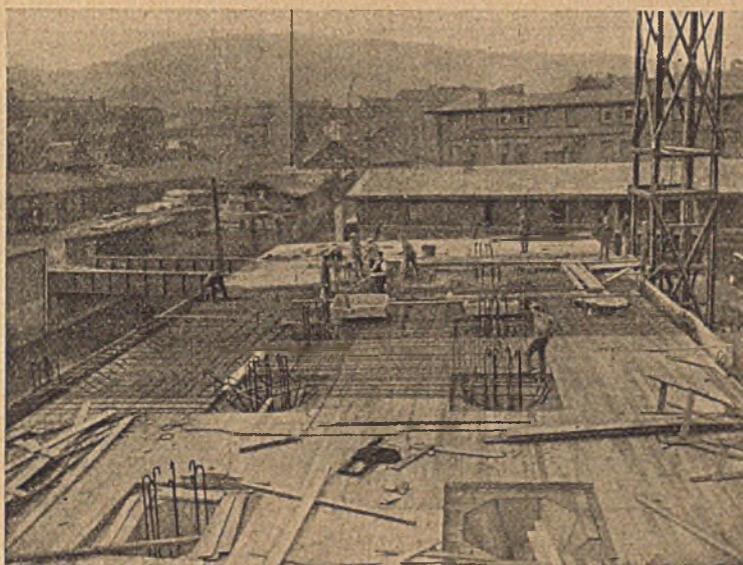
Pilzdecke in Schalung Acc-Fabr., Hagen.
